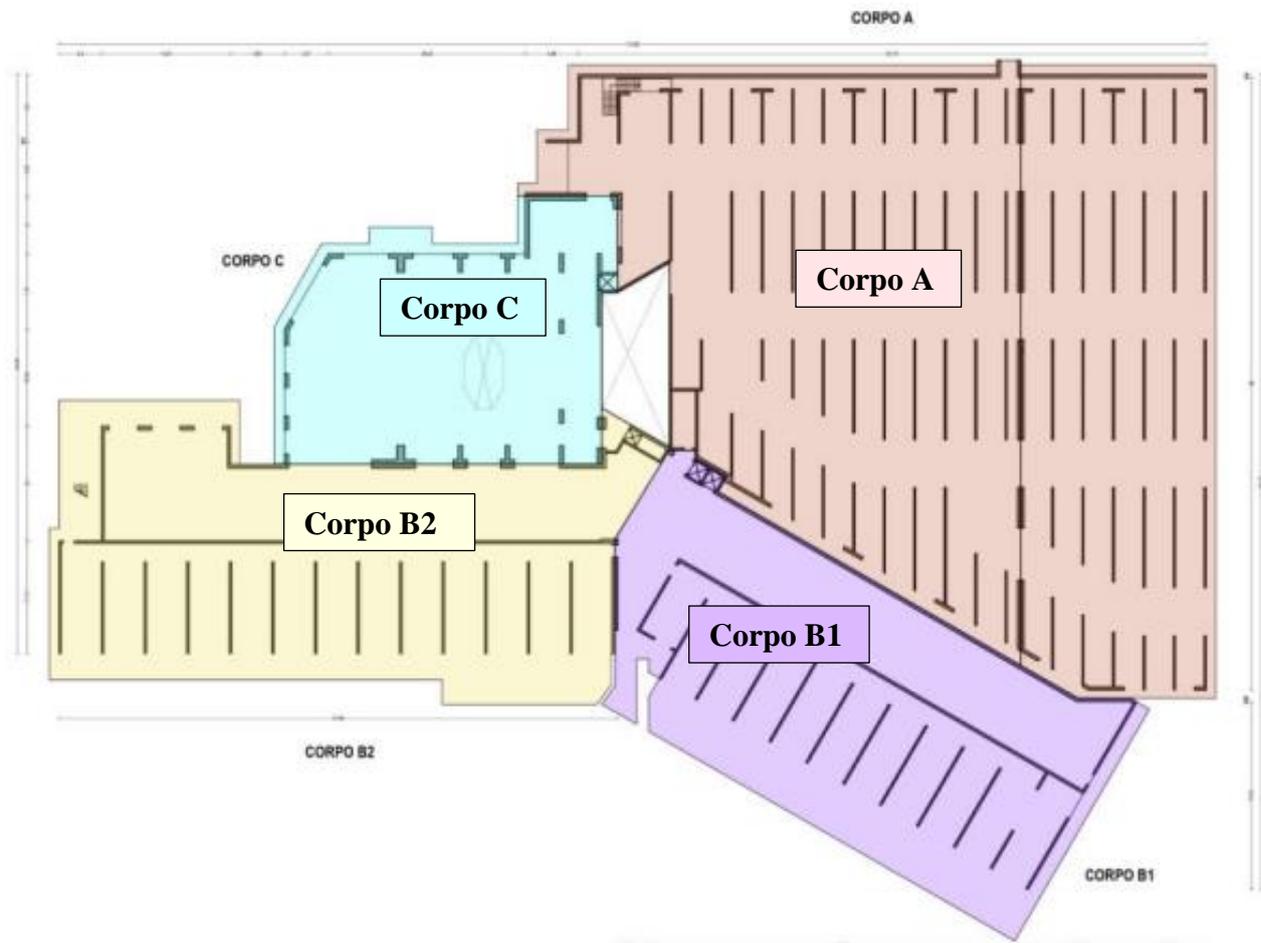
Suddivisione in blocchi funzionali del progetto strutturale originario – piano terra.
